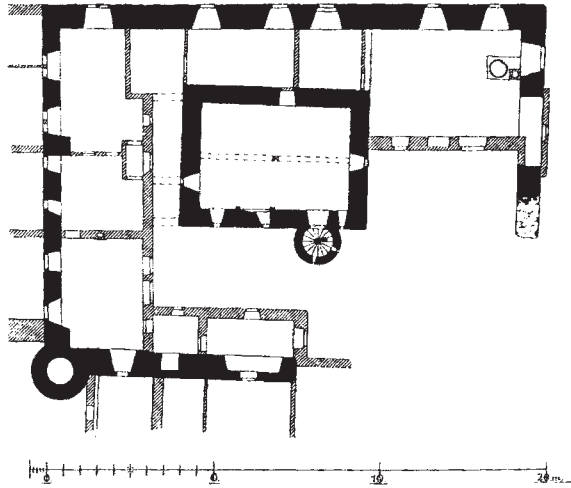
Wachenheim: Wachenheim. Grundriss (1887).
